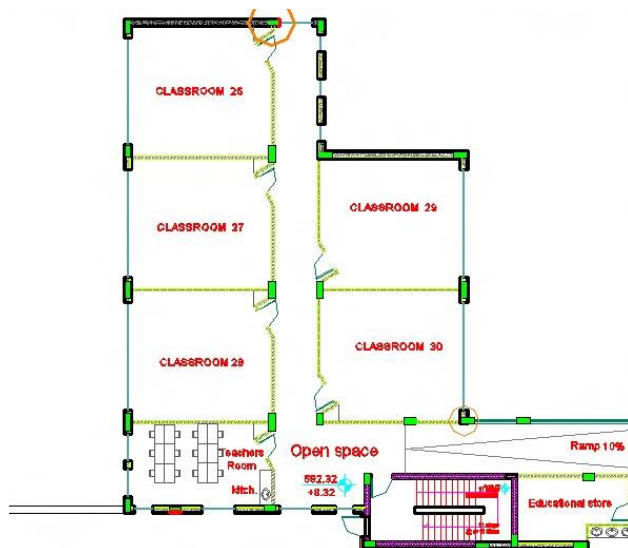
مسقط الطابق الثاني الجزء الأول.
